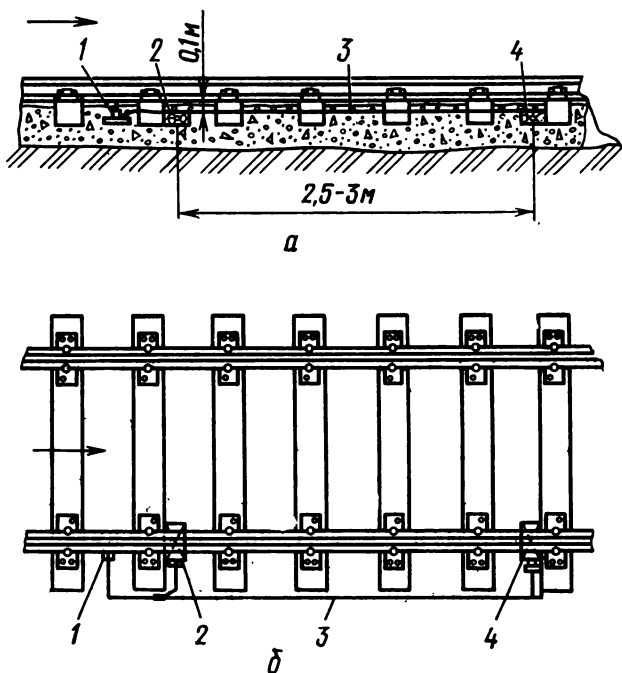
Установка ПВУ-79 с двумя разнесенными зарядами массой 3—4 кг:
